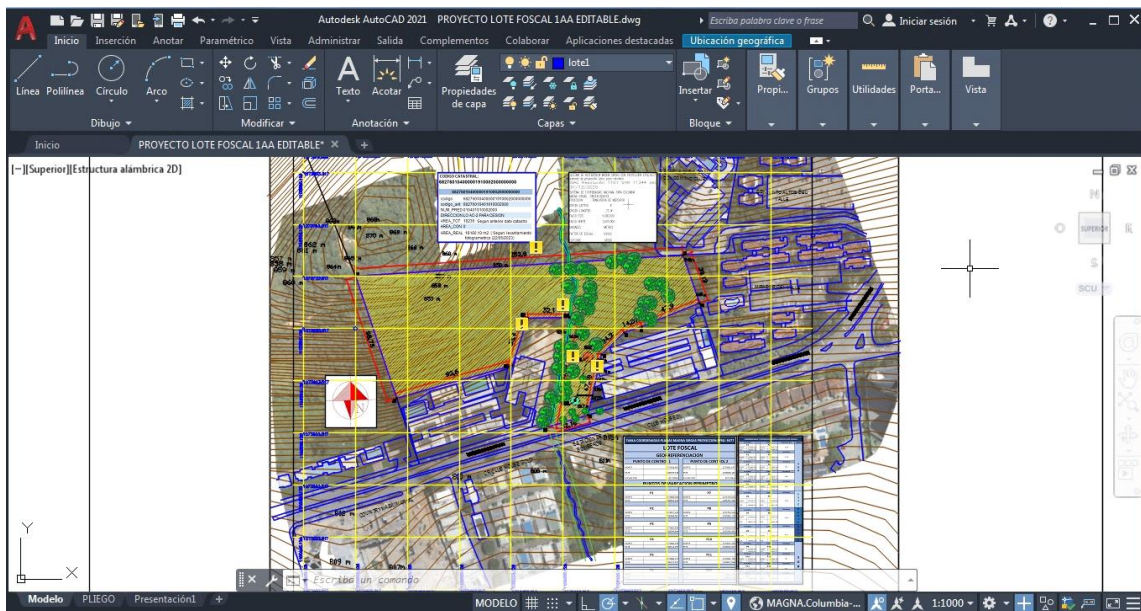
Elaboración Planimetría con ortomosaico escalado fase de la Fotointerpretación en AutoCAD. Parte III
